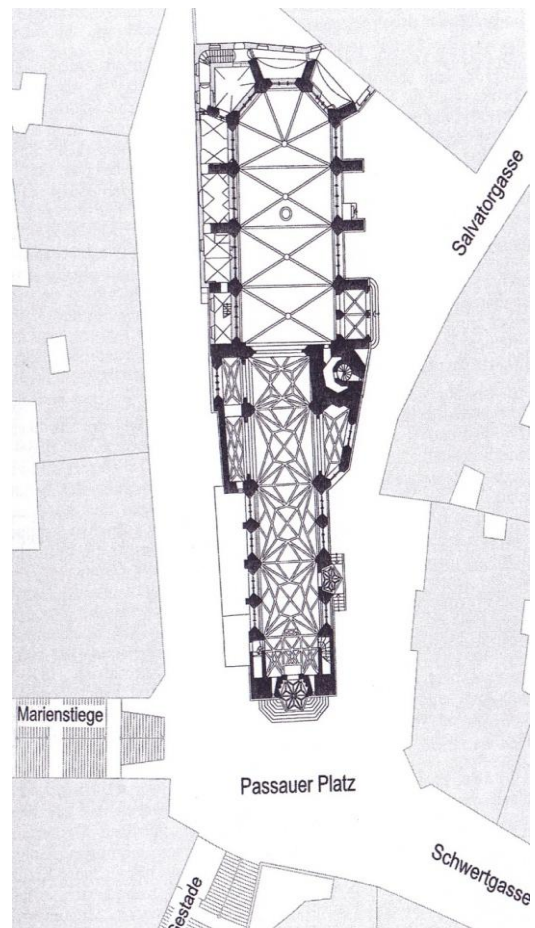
Wien, Maria am Gestade, Grundriss
